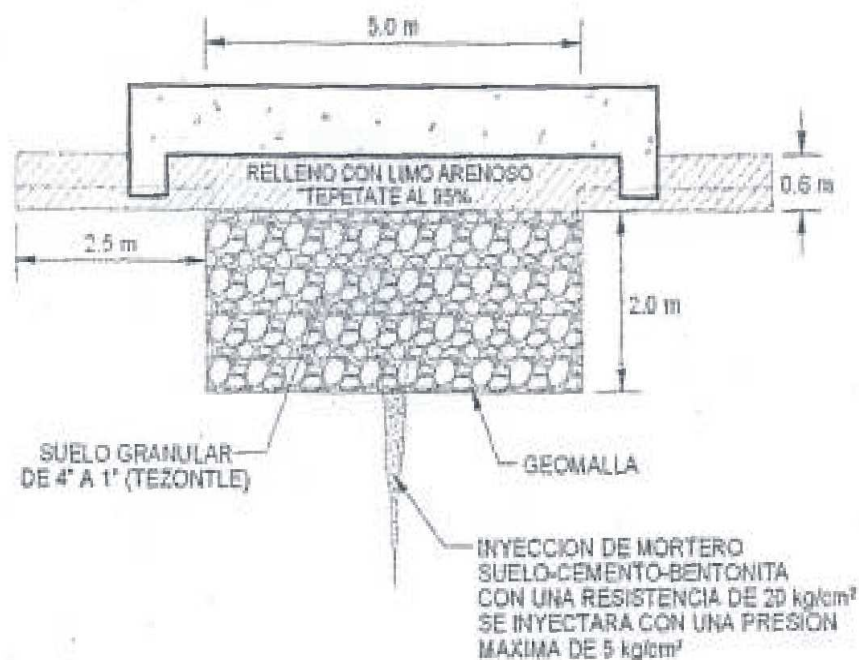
Recomendaciones para construir sobre grietas.
